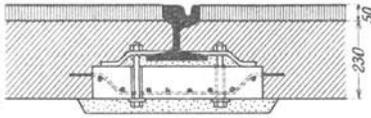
Schienenlagerung nach dem System Reinhardt.
